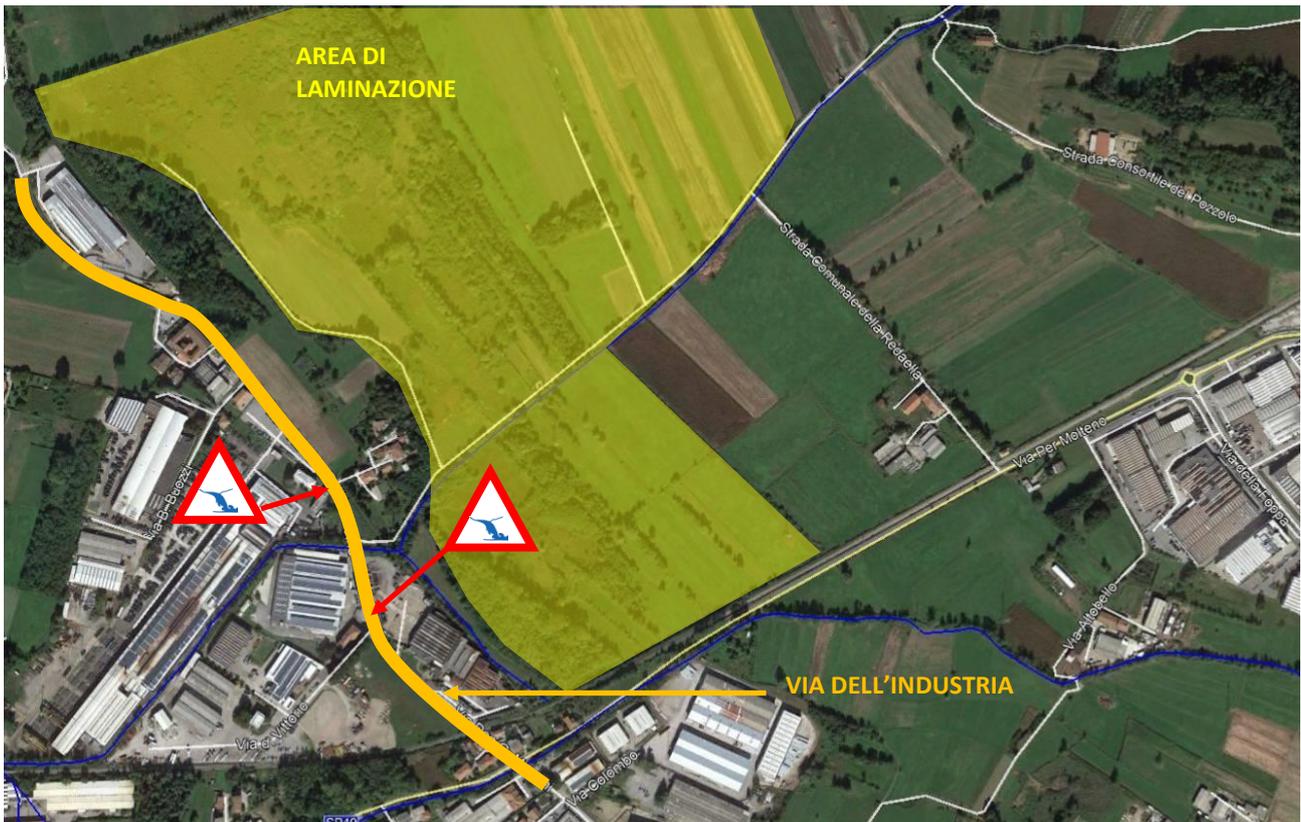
Indicazione planimetrica della segnaletica prevista su via dell'Industria
